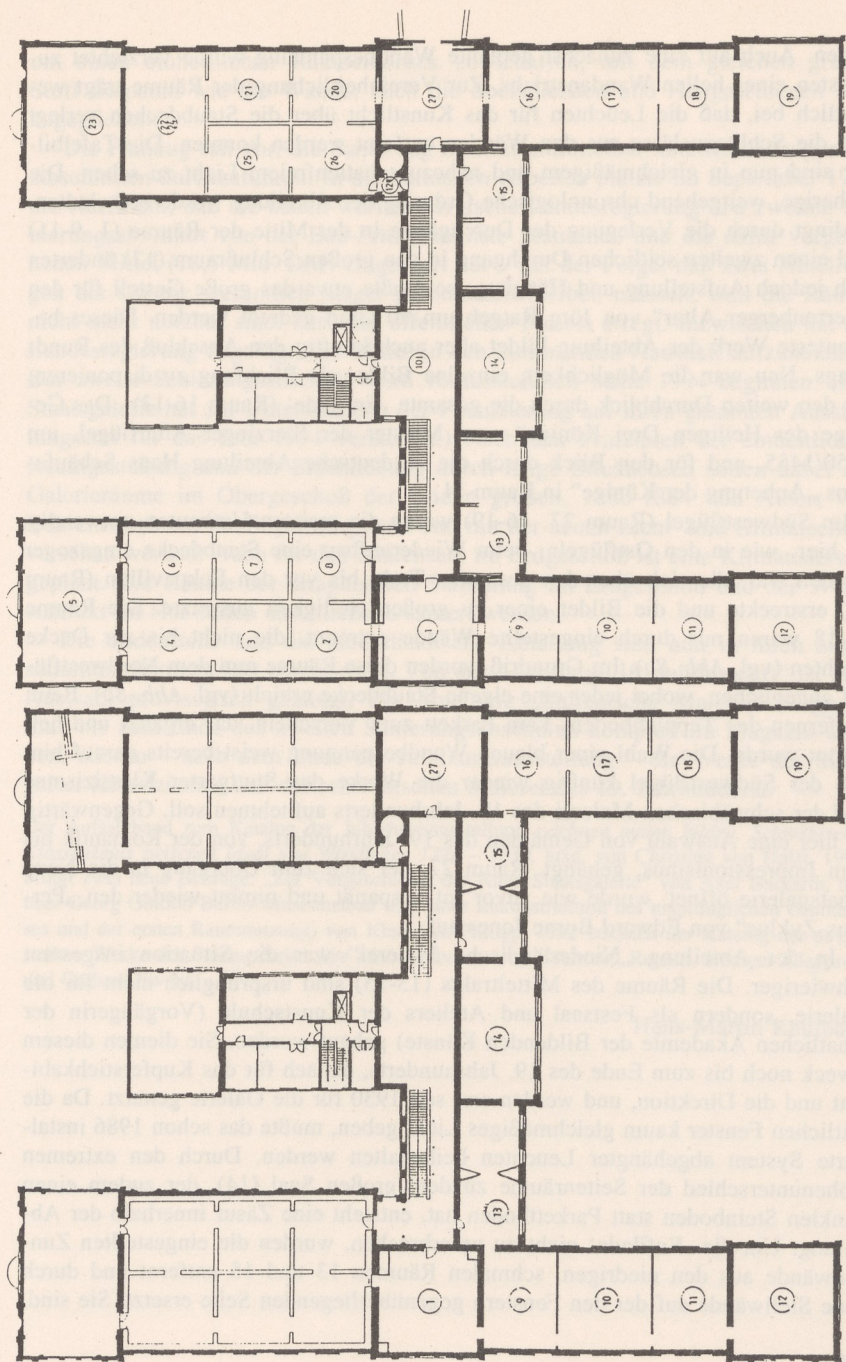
Stuttgart, Alte Staatsgalerie. Grundriß Obergeschoß 1958— Fig. 2 Stuttgart, Alte Staatsgalerie. Grundriß Obergeschoß seit 1993
